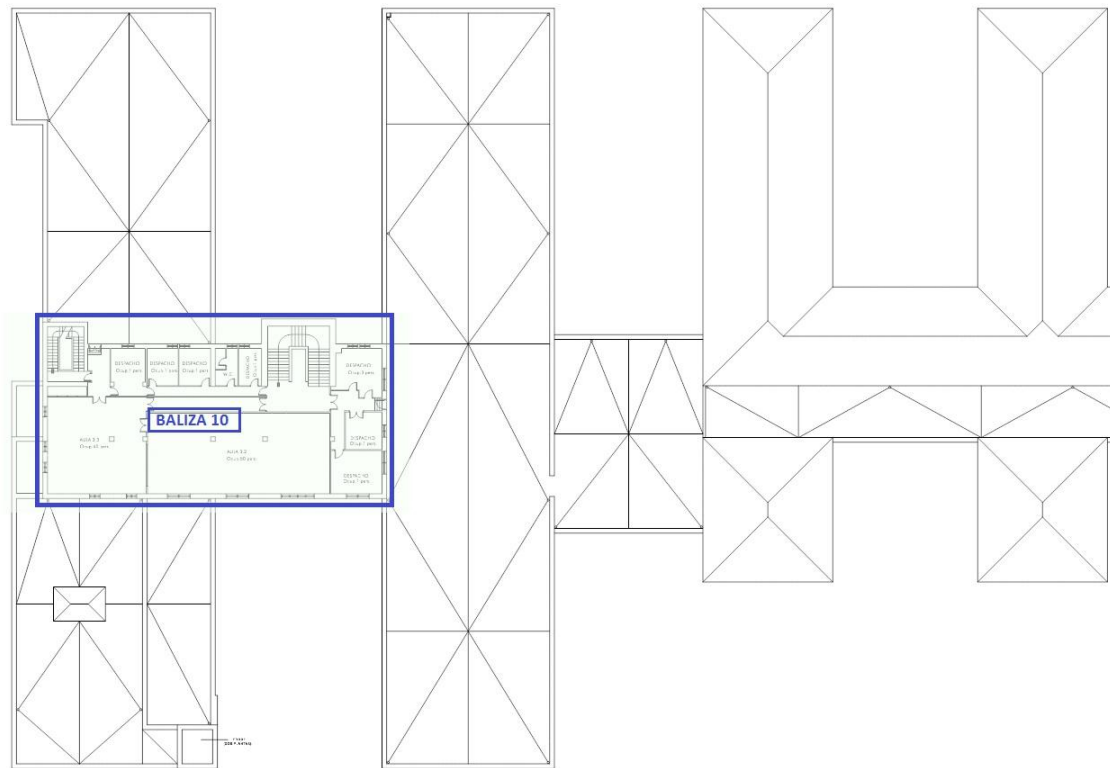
Plano balizas segunda planta con sectorizado entre plantas
